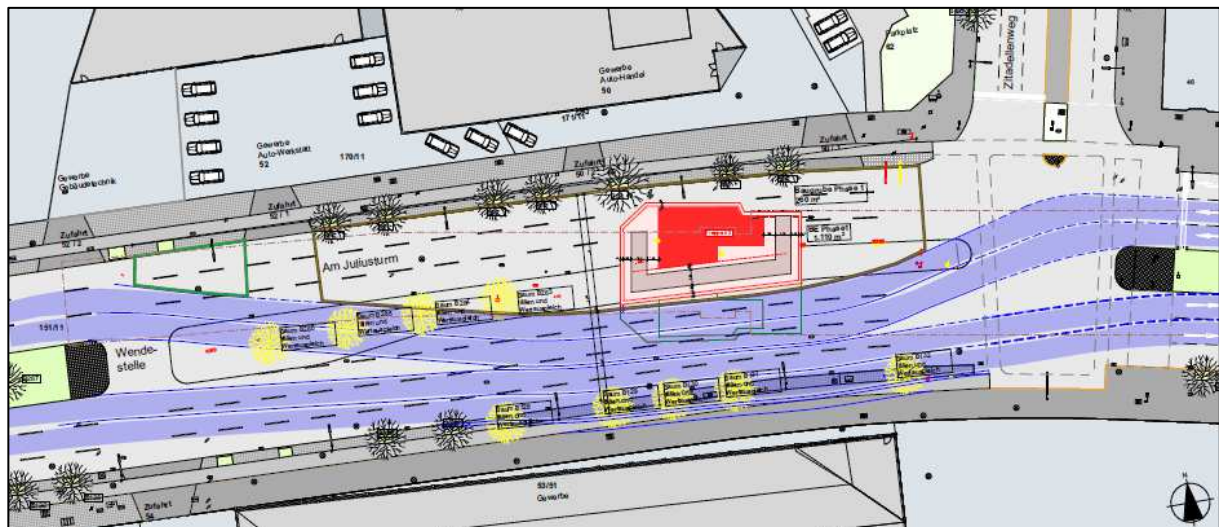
Ausschnitt Plan Zi\_PG 3a Baudurchführung (unmaßstäblich)
